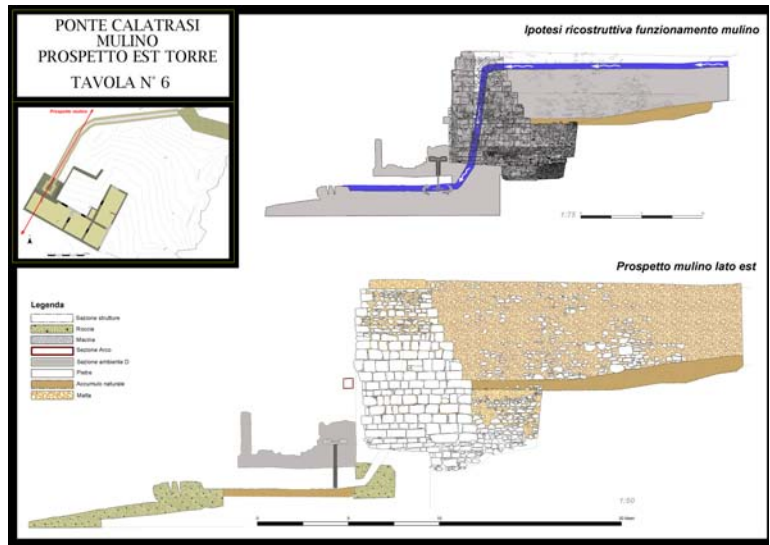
Prospetto orientale e ipotesi di funzionamento
